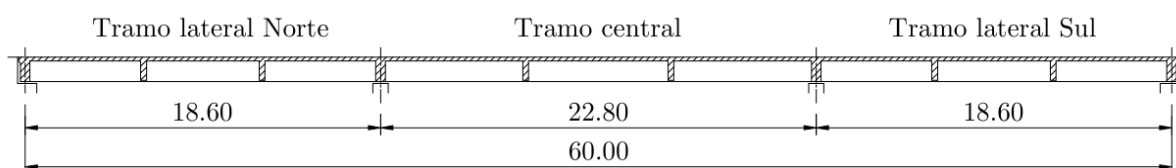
Corte longitudinal do tabuleiro. Jacinto (2011)
